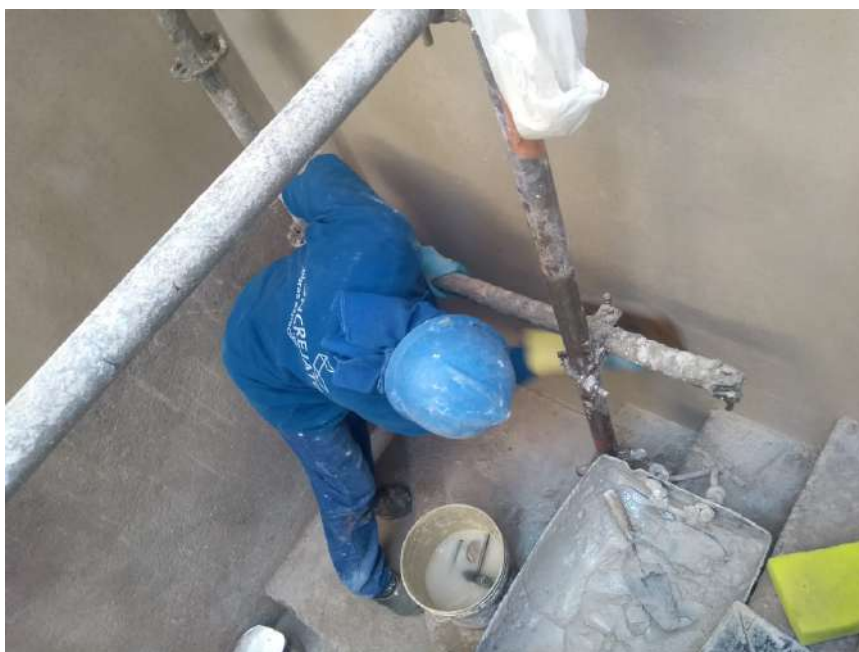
execução da argamassa de acabamento das paredes externas – Casa 07
